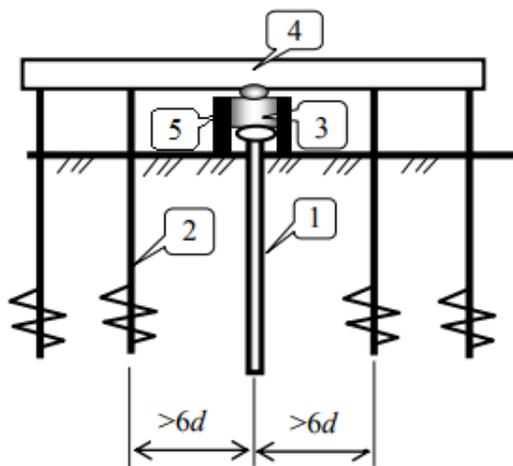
Схема установки стенда для испытания свай вдавливающими нагрузками
